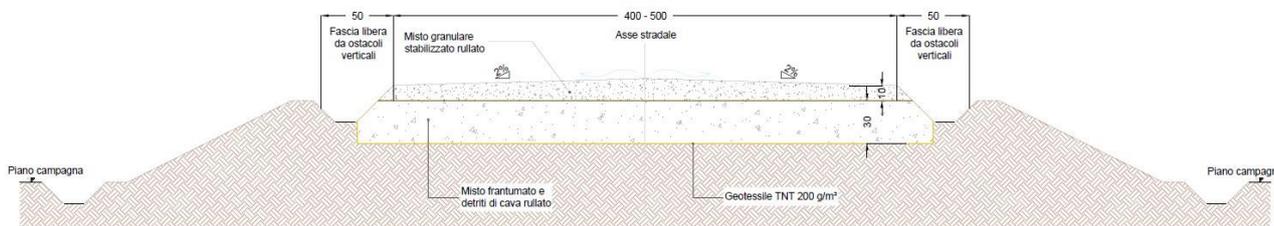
Sezione tipo pista di impianto su rilevato; misure in centimetri.
